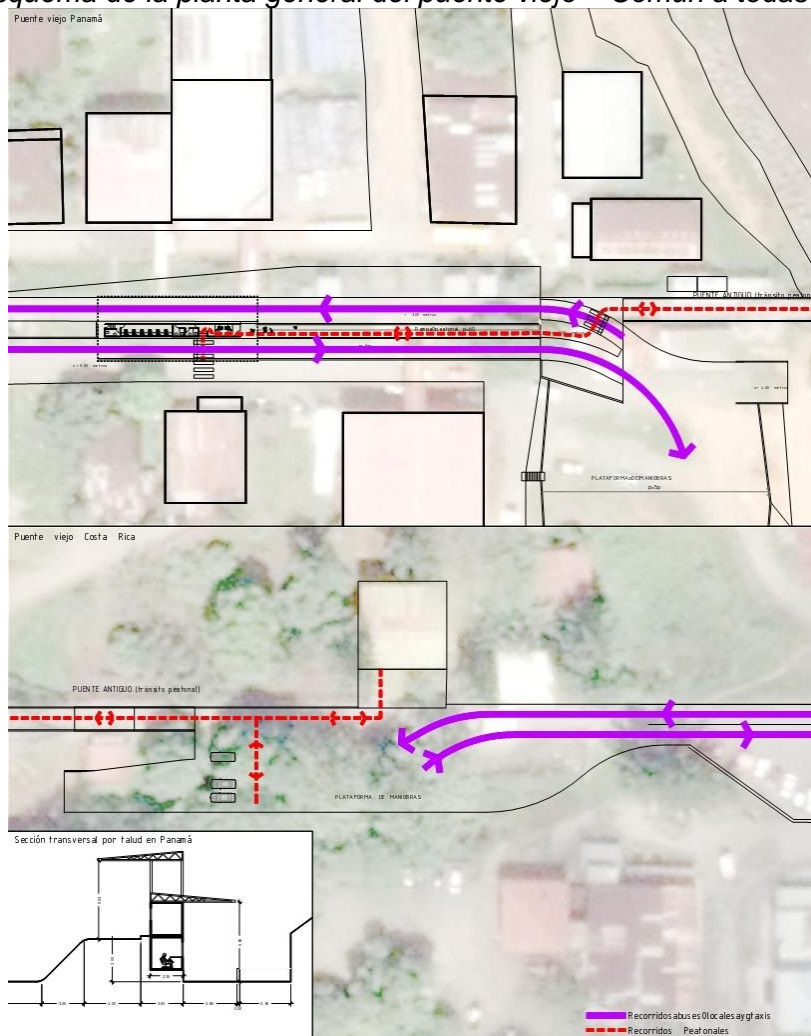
Esquema de la planta general del puente viejo – Común a todas las alternativa
